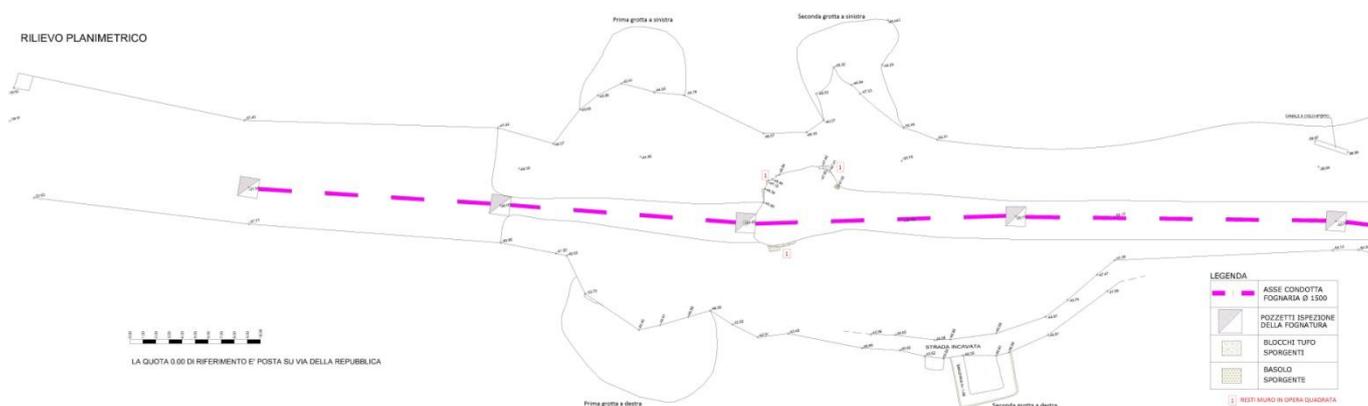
Planimetria del complesso santuarioale (eseguito dallo studio Azimut Progetti).
